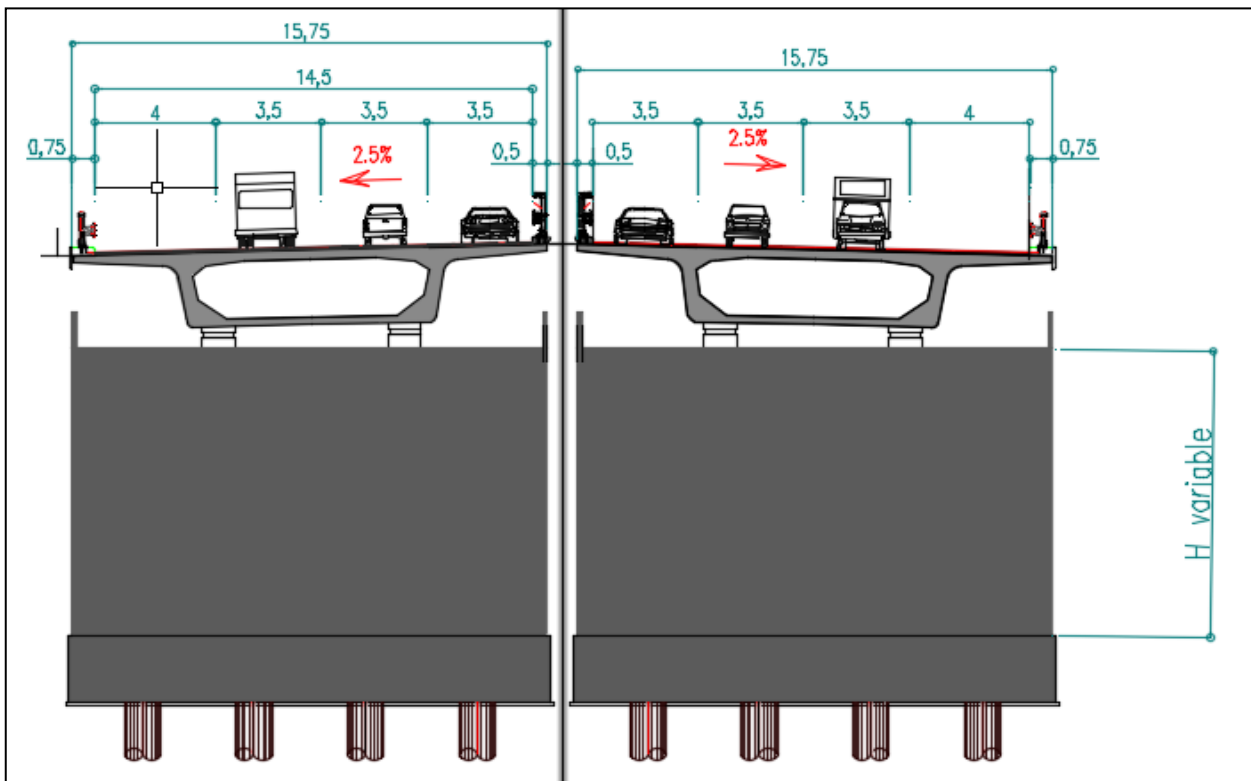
Coupe transversale sur culée VARIANTE 02
